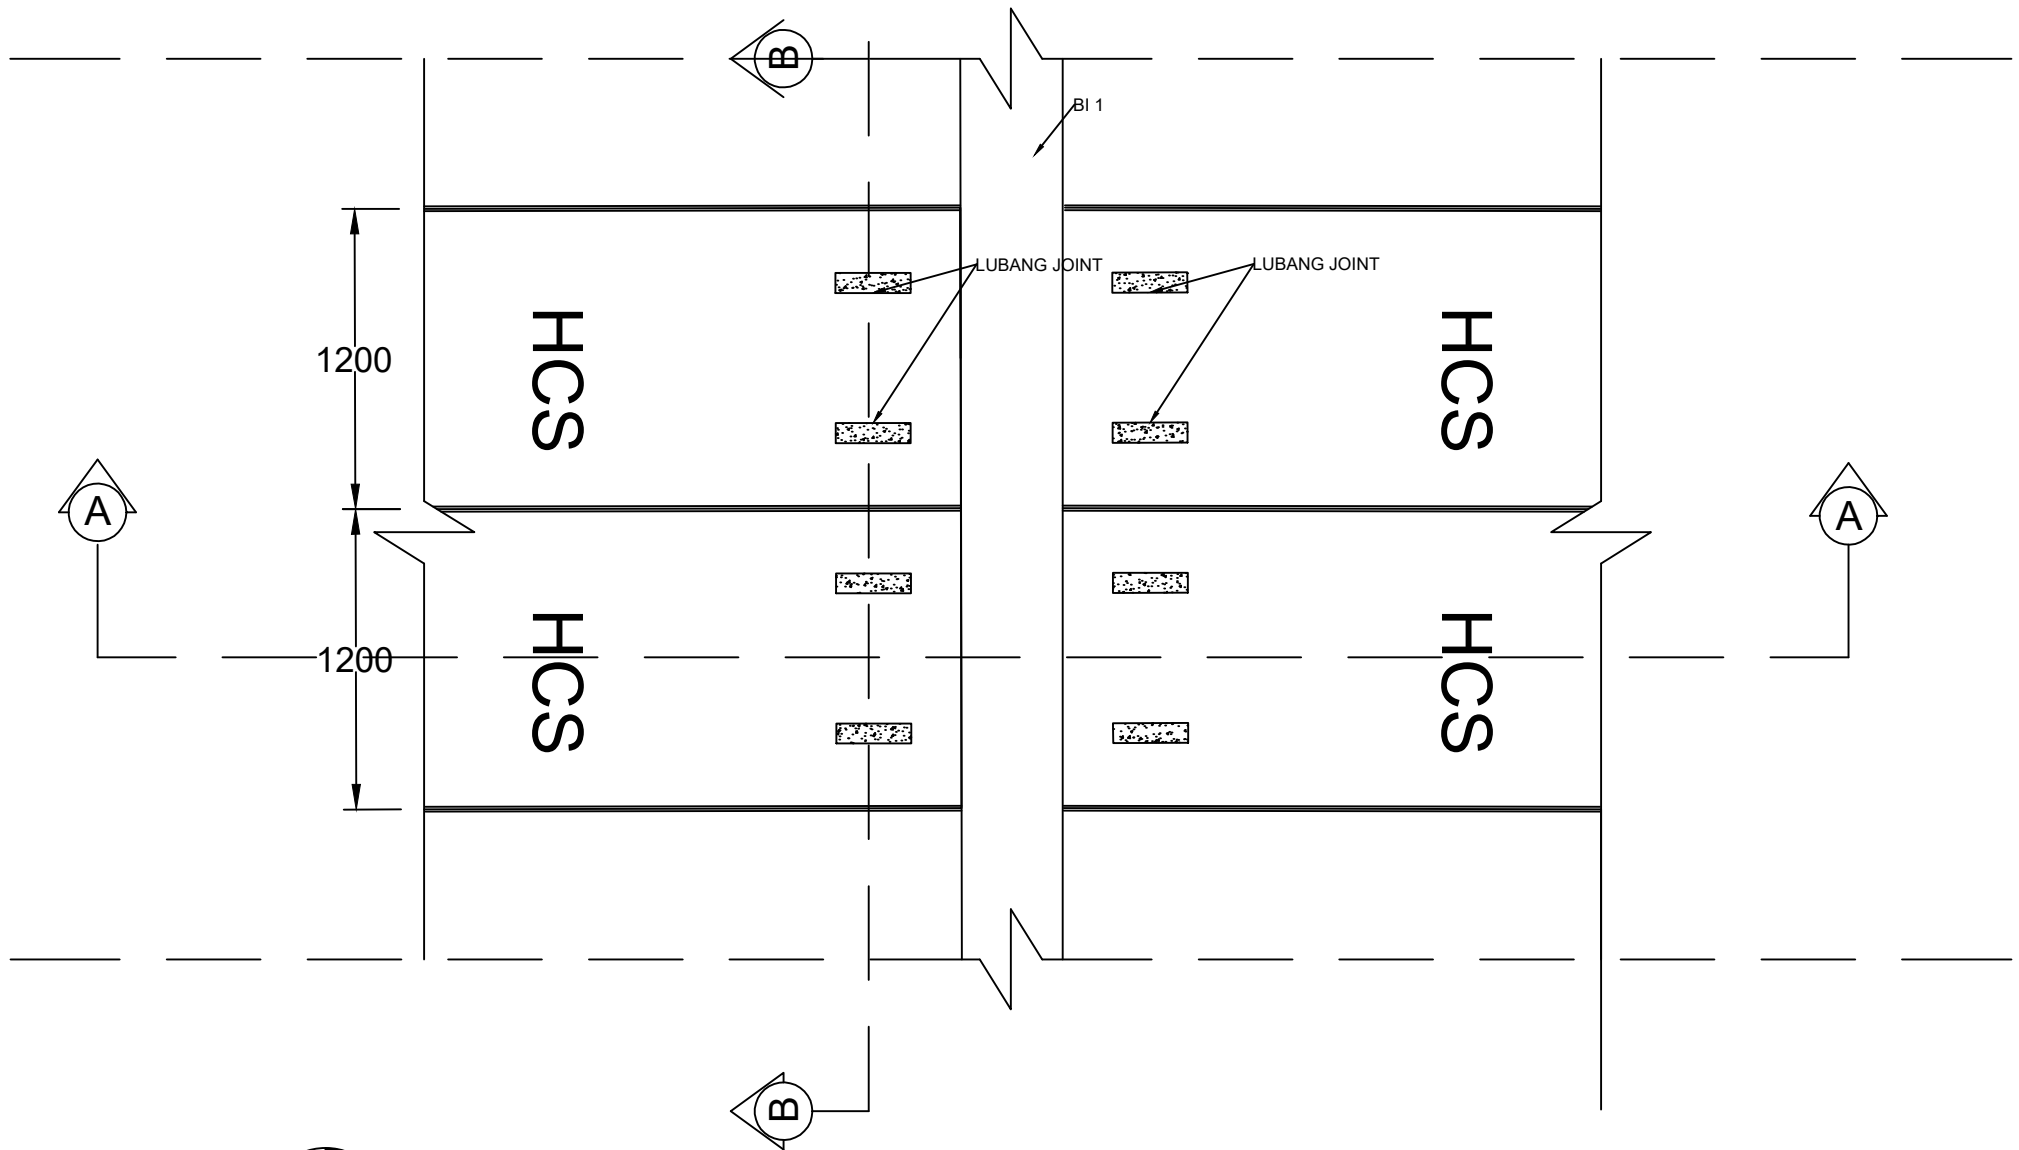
DETAIL SAMBUNGAN BALOK INDUK BALOK ANAK
